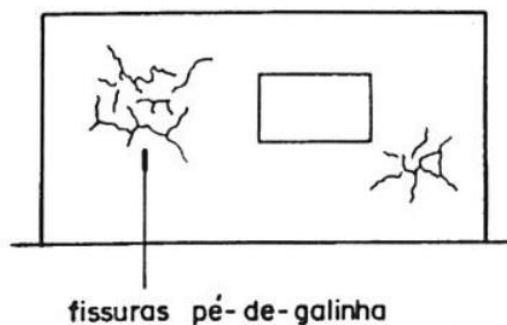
Fissuração por detalhe construtivo incorreto.
